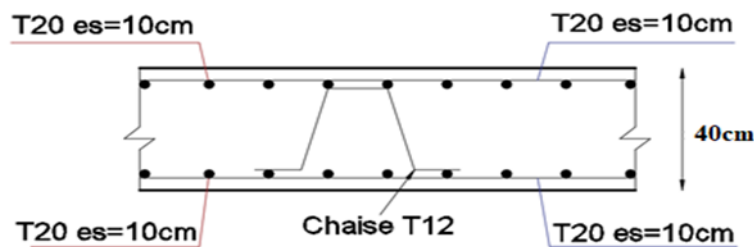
Schéma de ferrailage de la dalle du radier.
